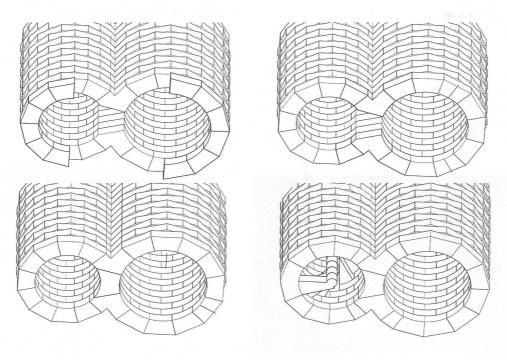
Hipotética secuencia de fases constructivas (Ruiz-Cristini-López Salas)
